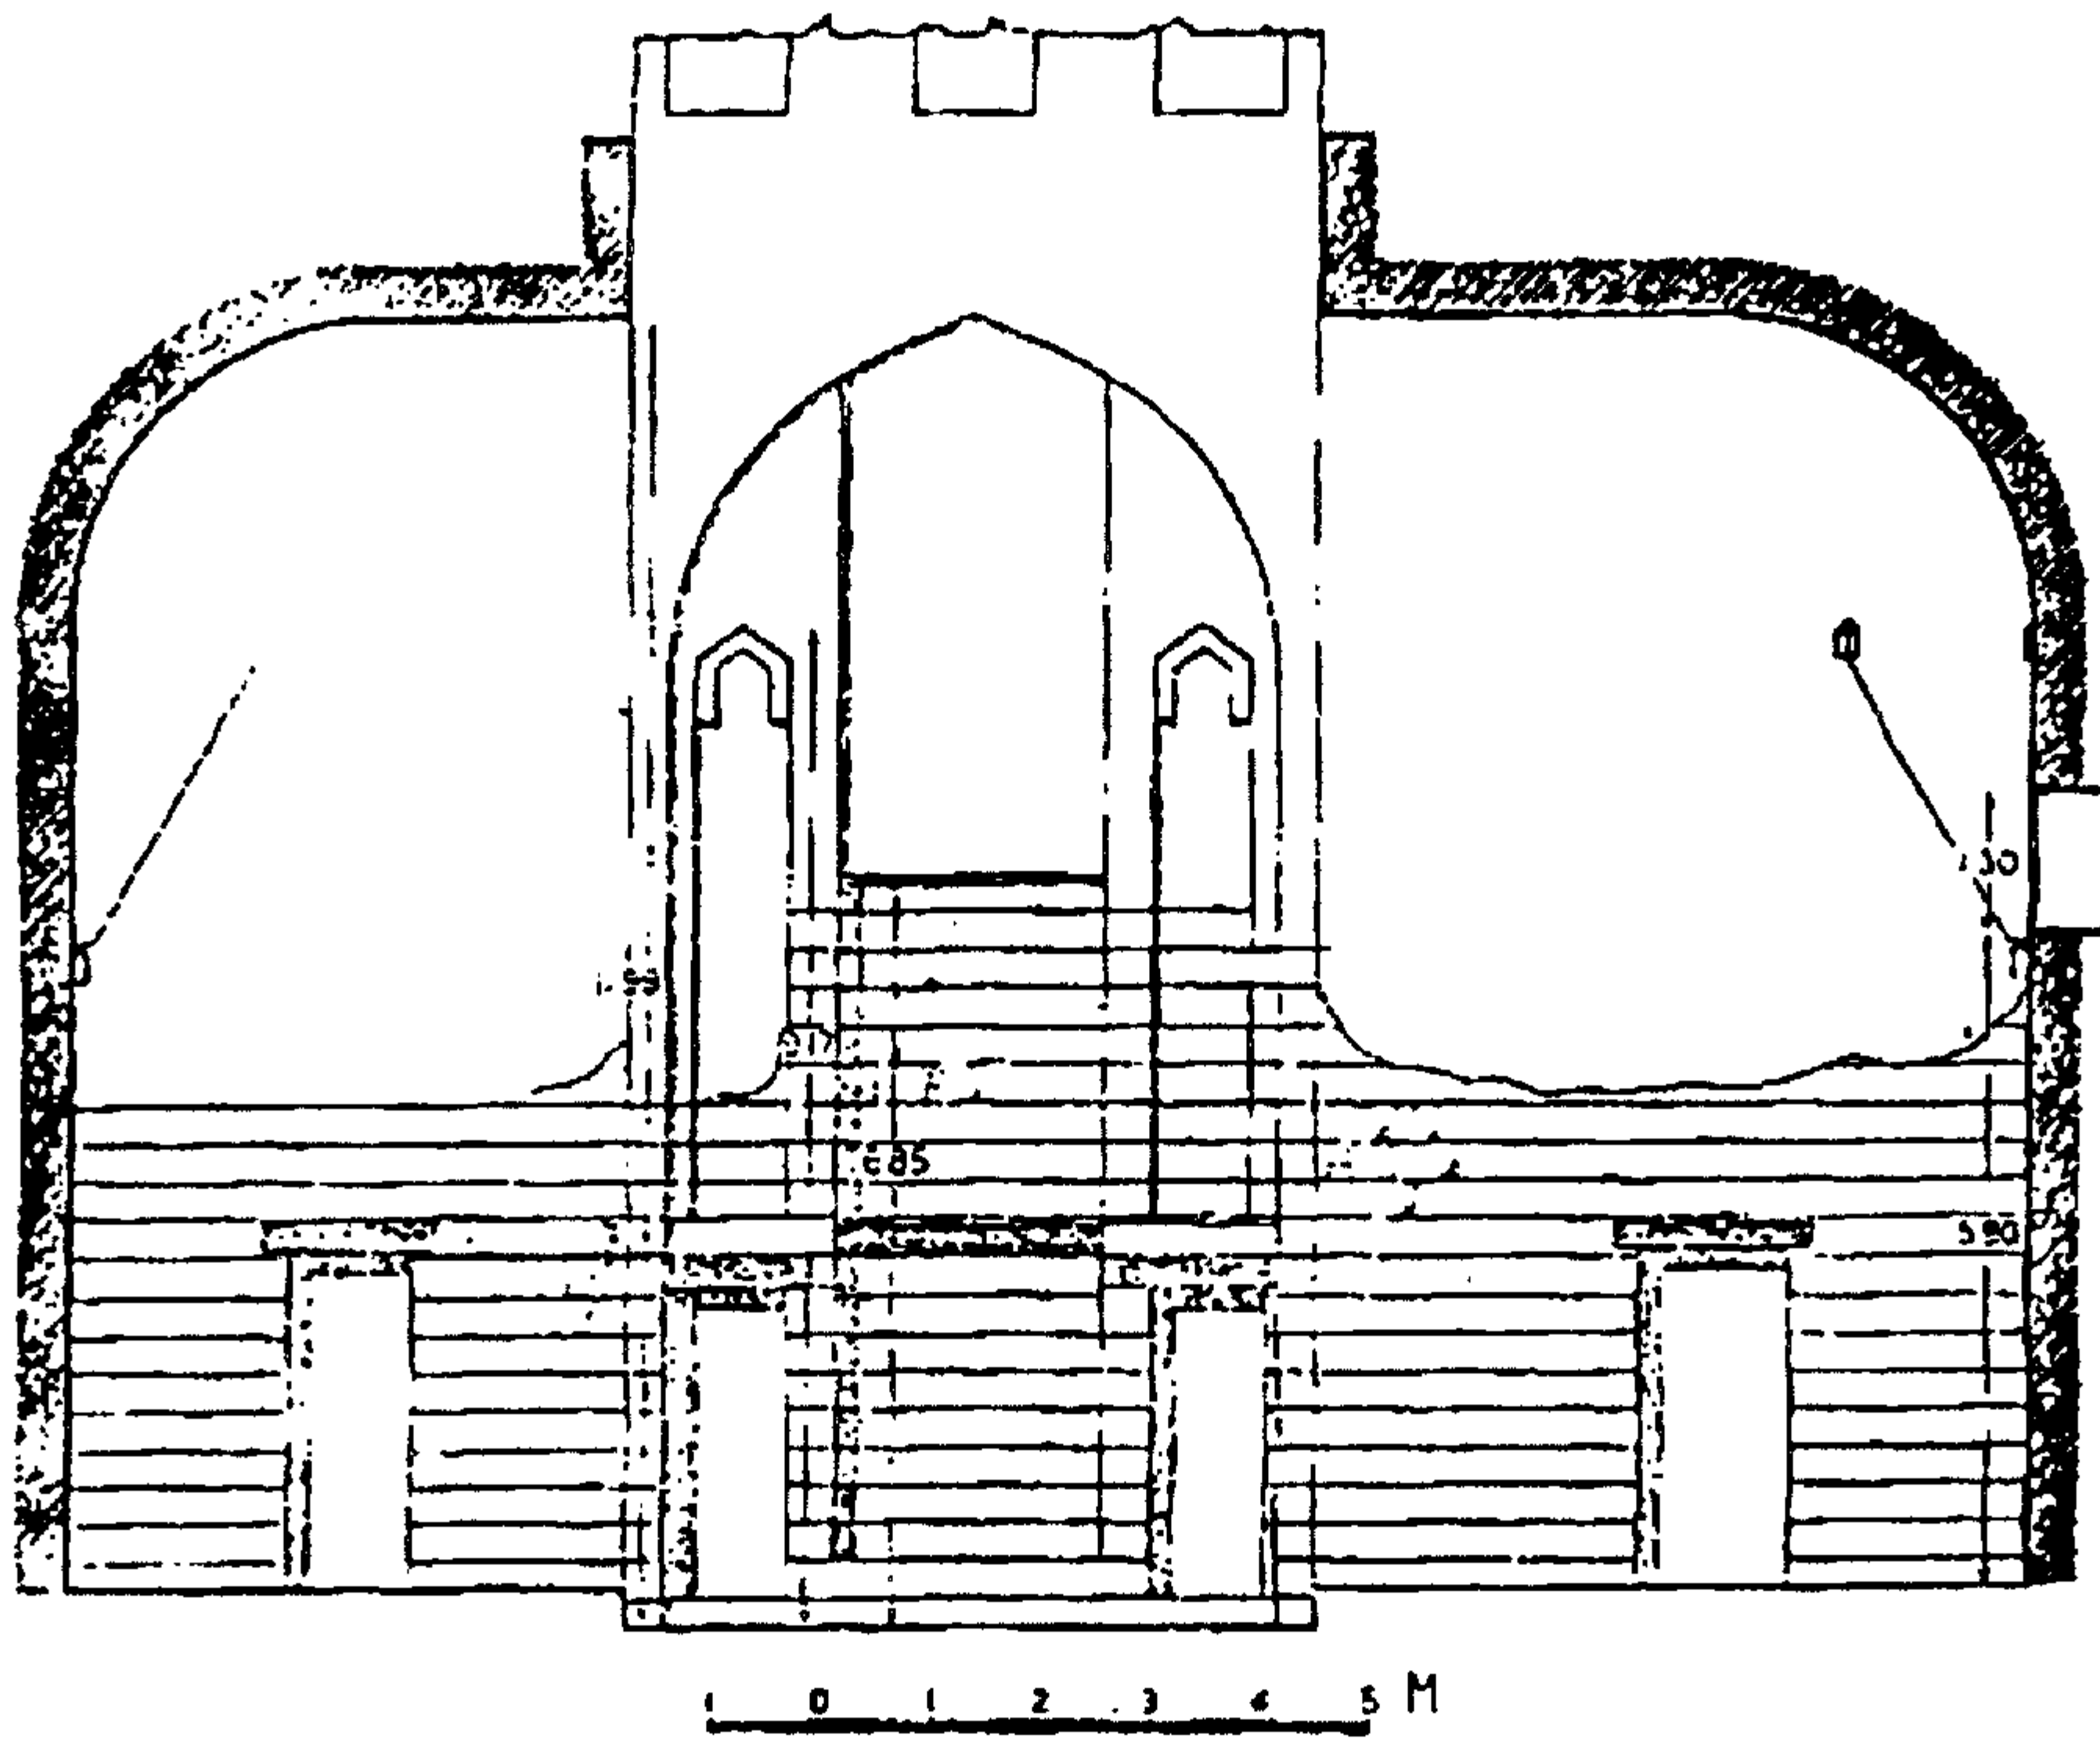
مسقط أفقى لباب القنطرة .
